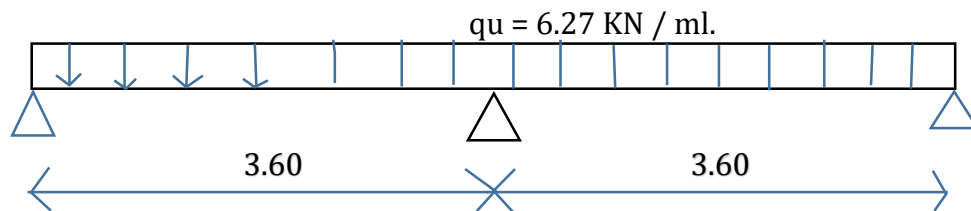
Figure III.C : Schéma statique de la poutre continue reposant sur 3 appuis.
